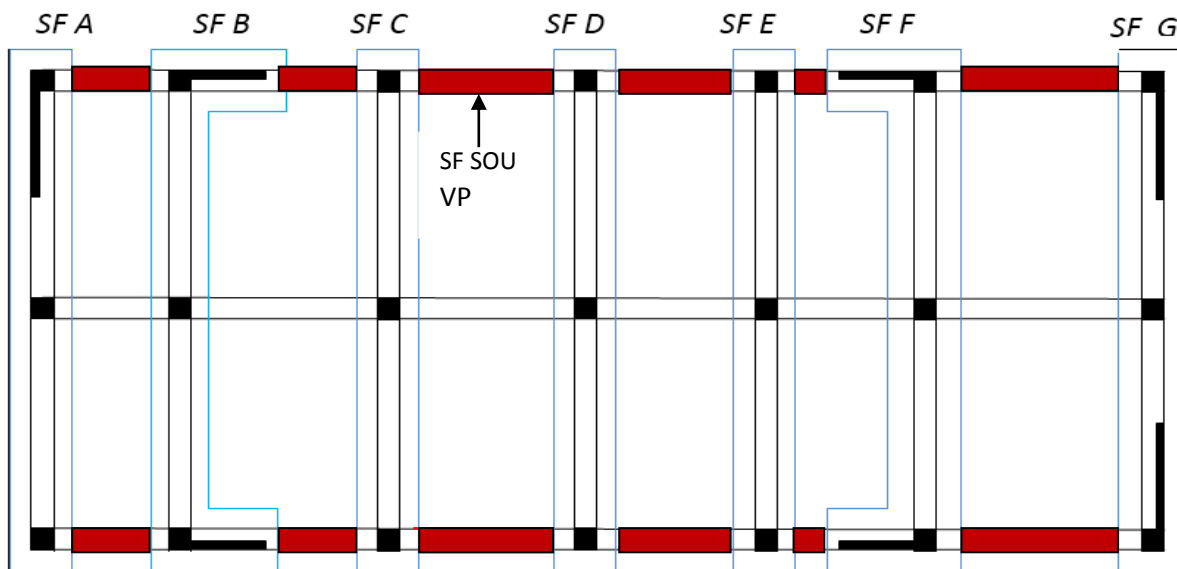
Vue en plan de la disposition des semelles filantes.
